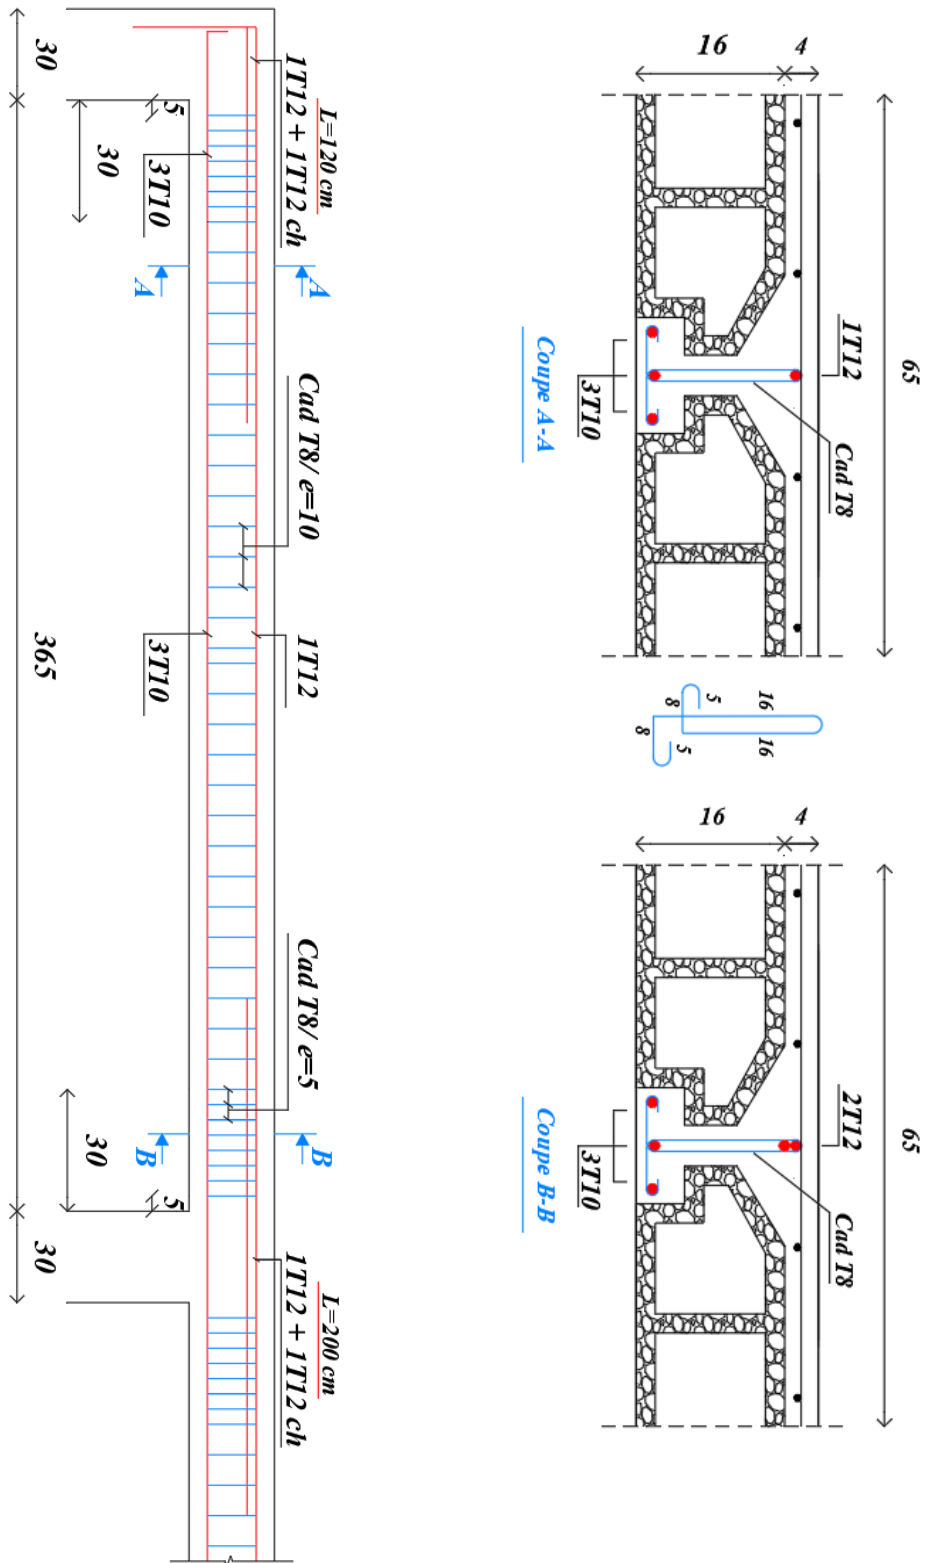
Schéma de ferrailage du plancher à corps creux
